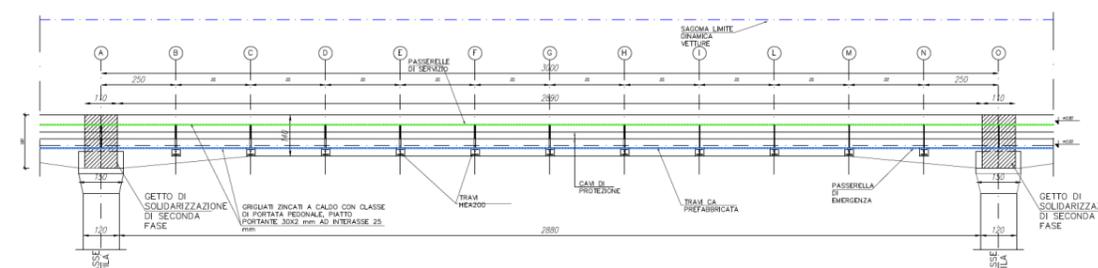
Sezione tipo in viadotto - sezione longitudinale
